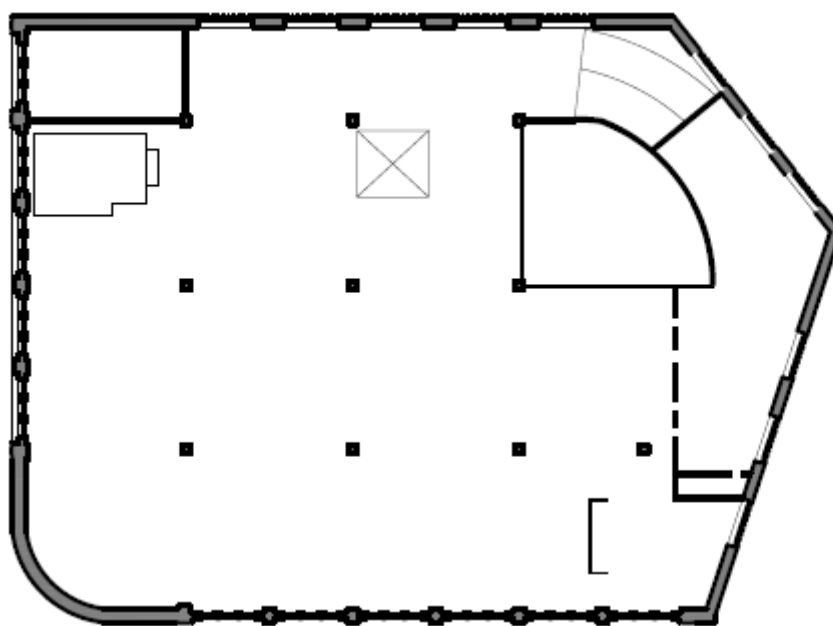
Planta Piso 2 Existente Escala 1/500 (Autora,2019)
